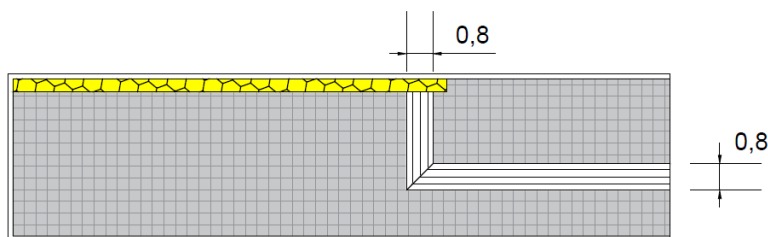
Elements de pavimentació accessibles a parades d'autobús
